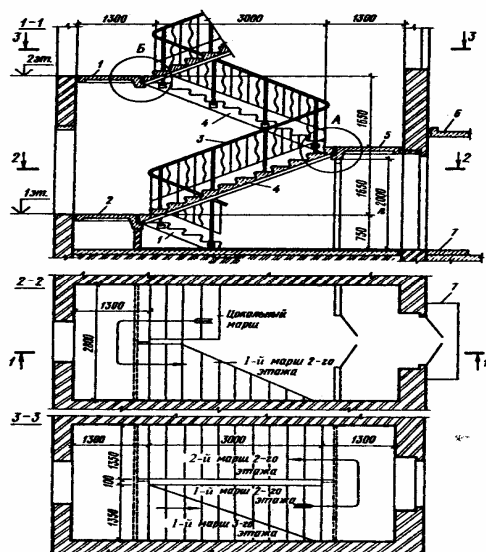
Двухмаршевая лестница (разрез и поэтажные планы):
